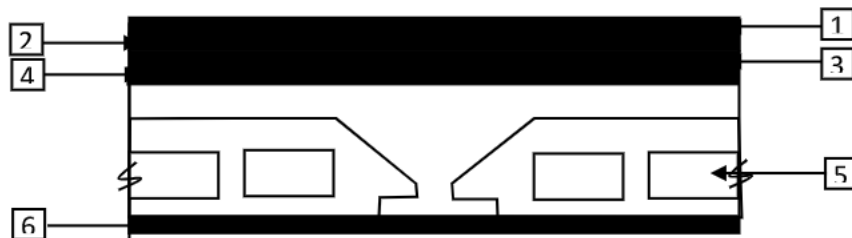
Coupe transversale d'un plancher terrasse inaccessible en corps creux
